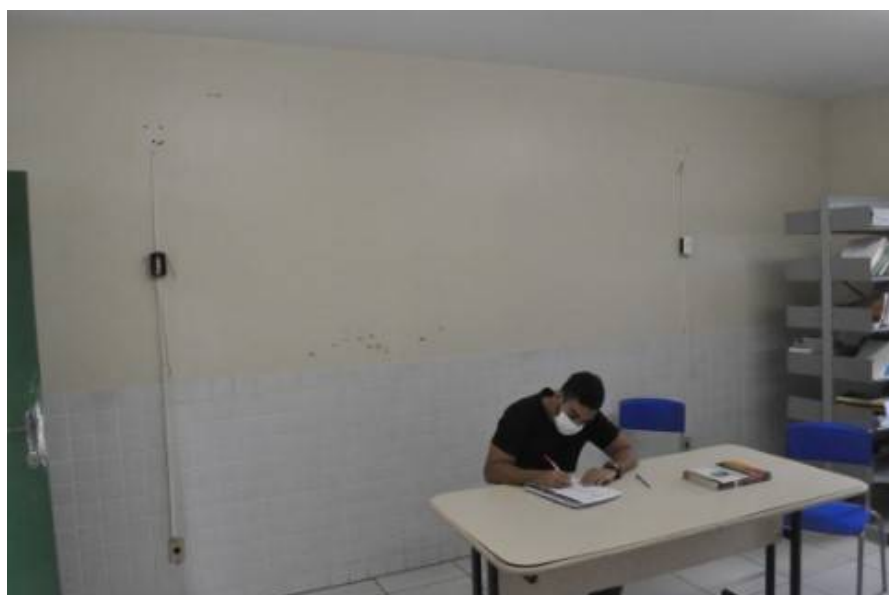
Vista geral: Parede esquerda da biblioteca.
